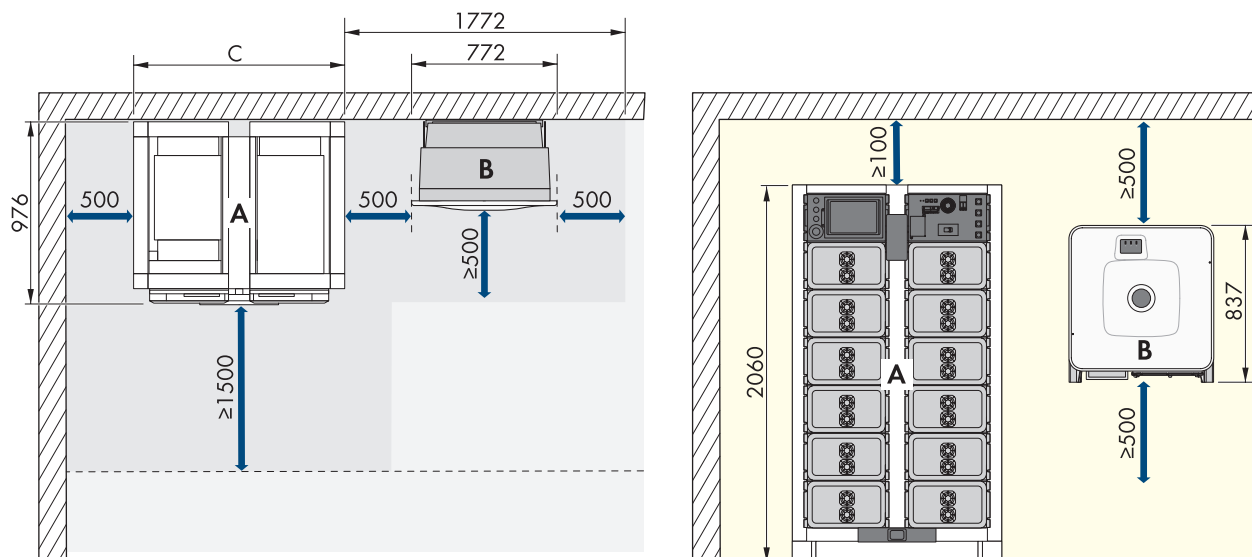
Esempio di installazione di un sistema con 1 armadio batterie (misure in mm)
